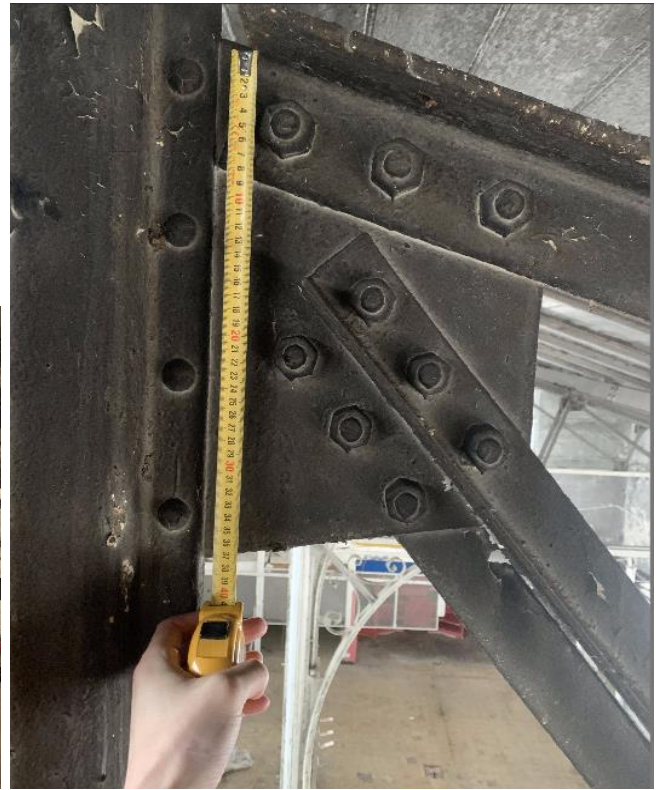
Kopnes augšjoslas balsta mezgls pie kolonnas.
